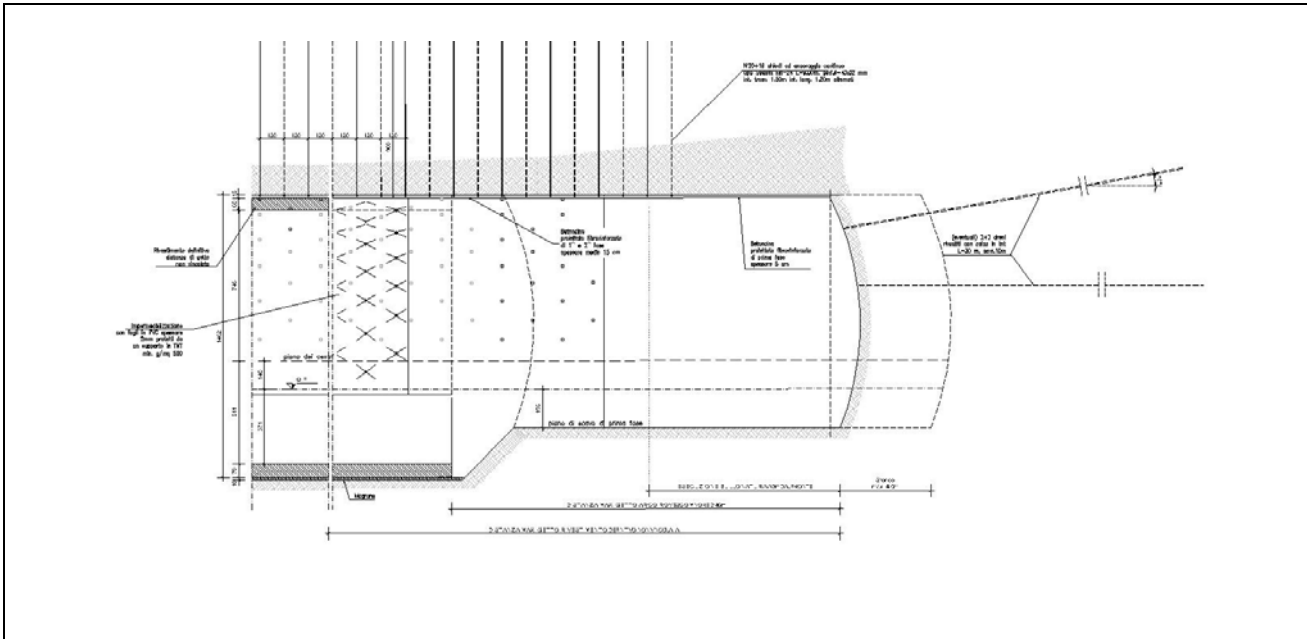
Sezione di scavo tipo GD-PS-A1 – PIAZZOLA DI SOSTA - Sezione longitudinale
